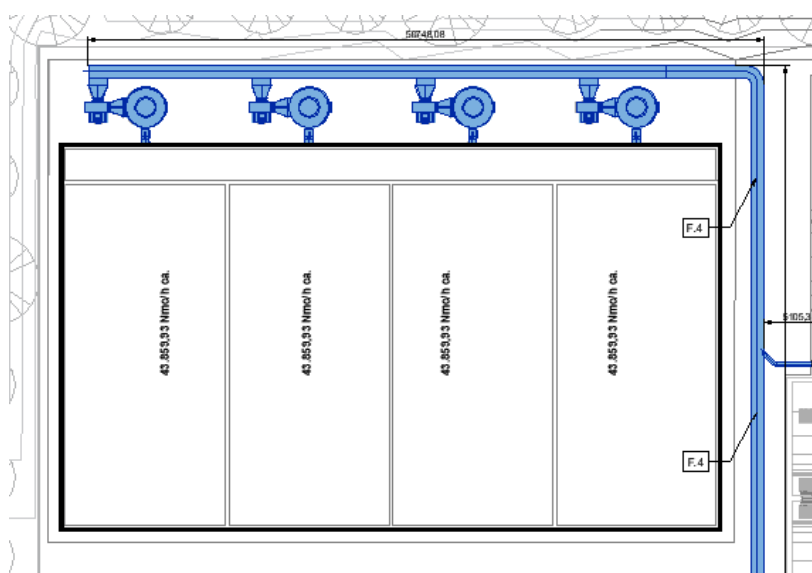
planimetria dell'area di biofiltrazione in progetto
